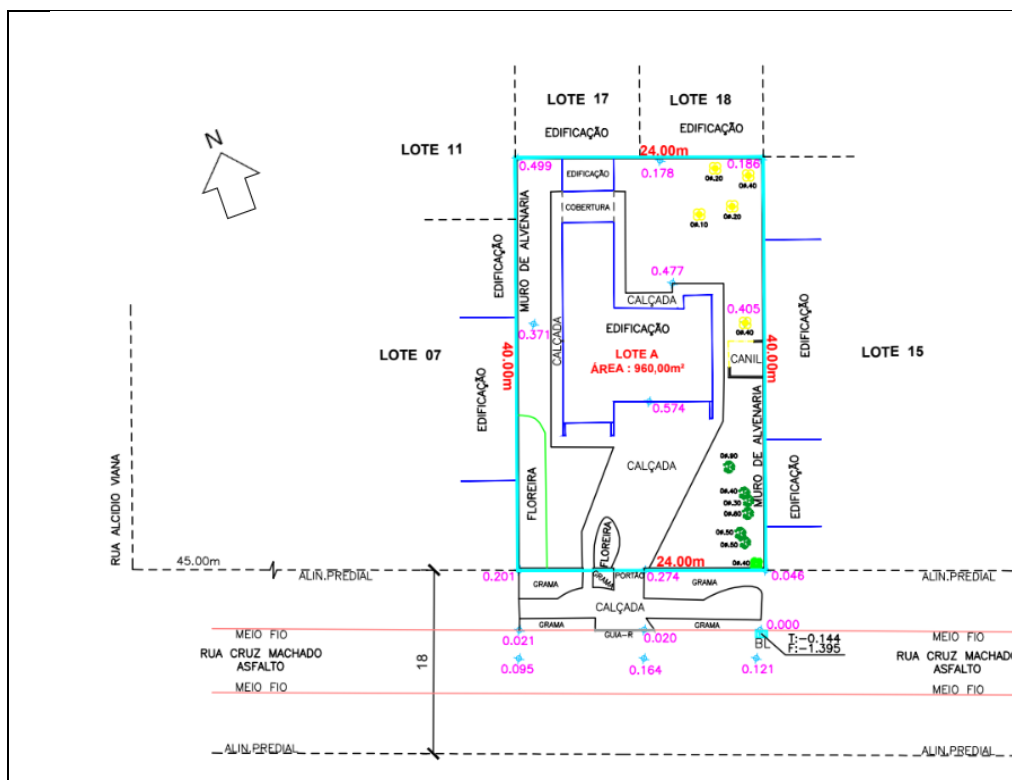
Planta do Levantamento Topográfico do Lote A onde está implantado o Novo Condomínio.
